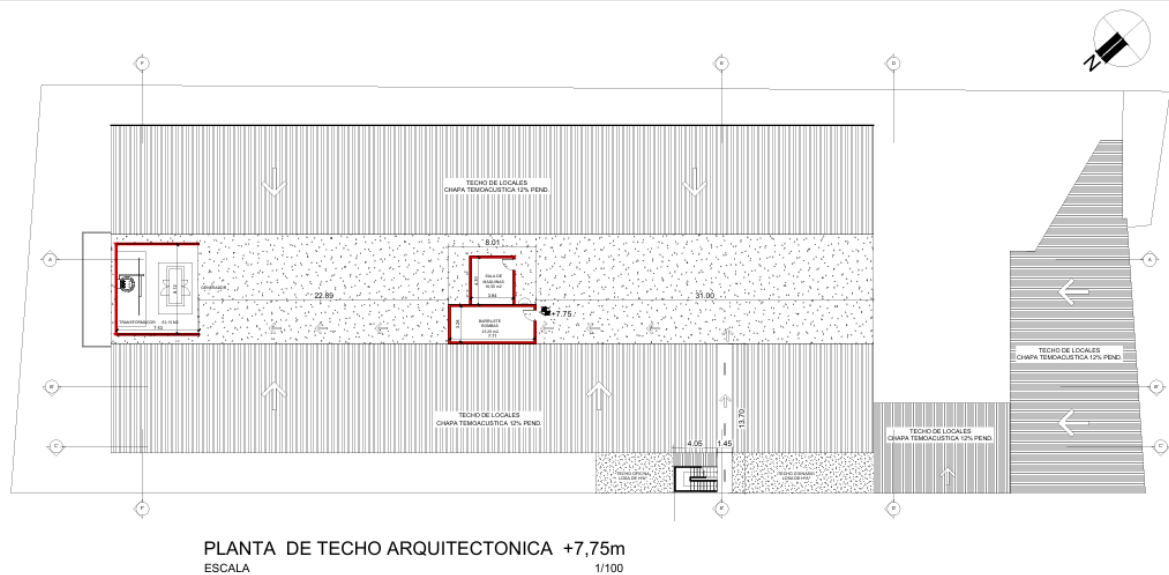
Planta de techo arquitectónica del Paseo Comercial
